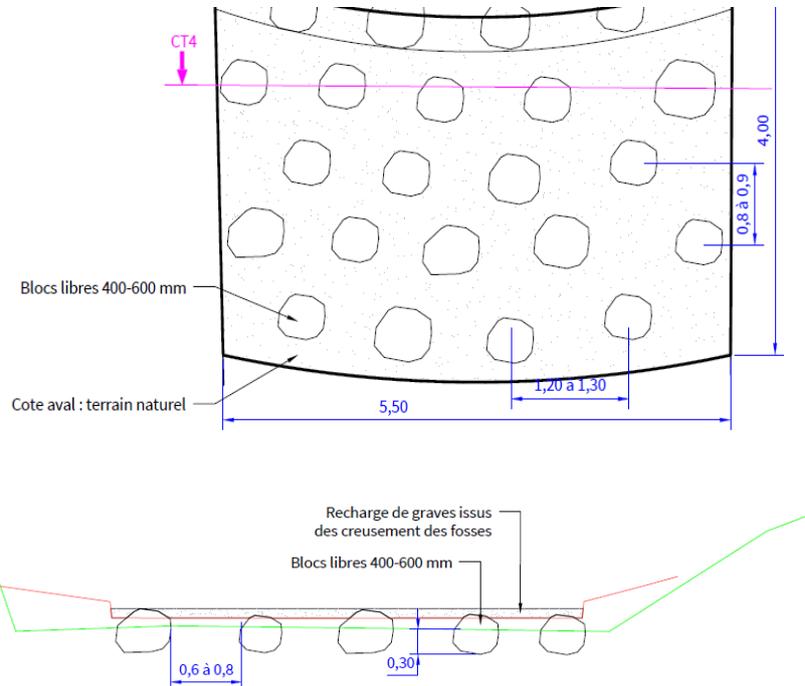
Vue en plan et coupe d'une rugosité de fond - (échelle non précisée - cf. annexe2: cahier de plans)
